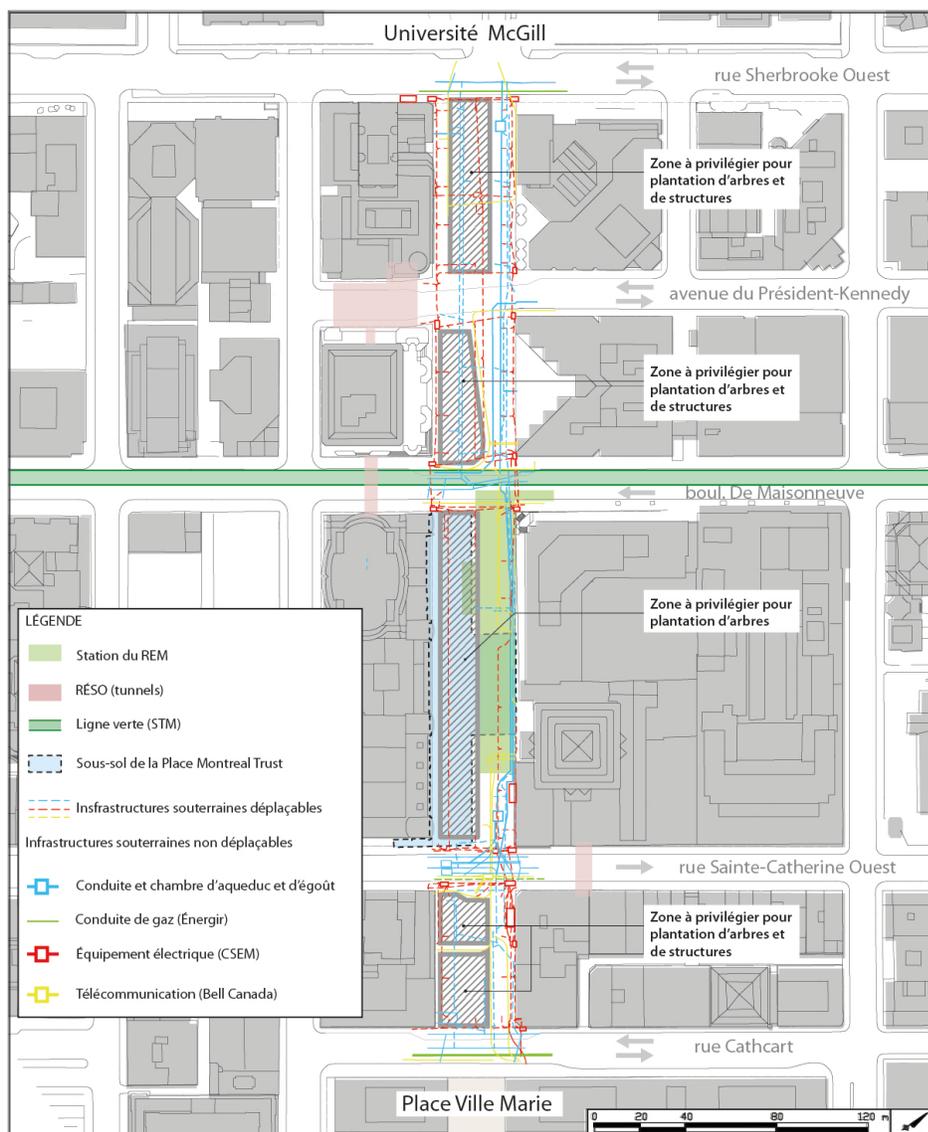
Plan de localisation des infrastructures souterraines.
